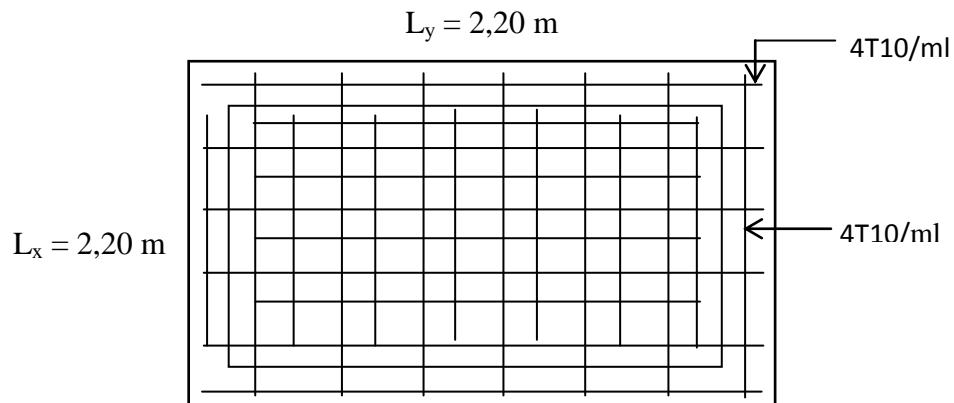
Ferrailage inférieur de la dalle de l'ascenseur
